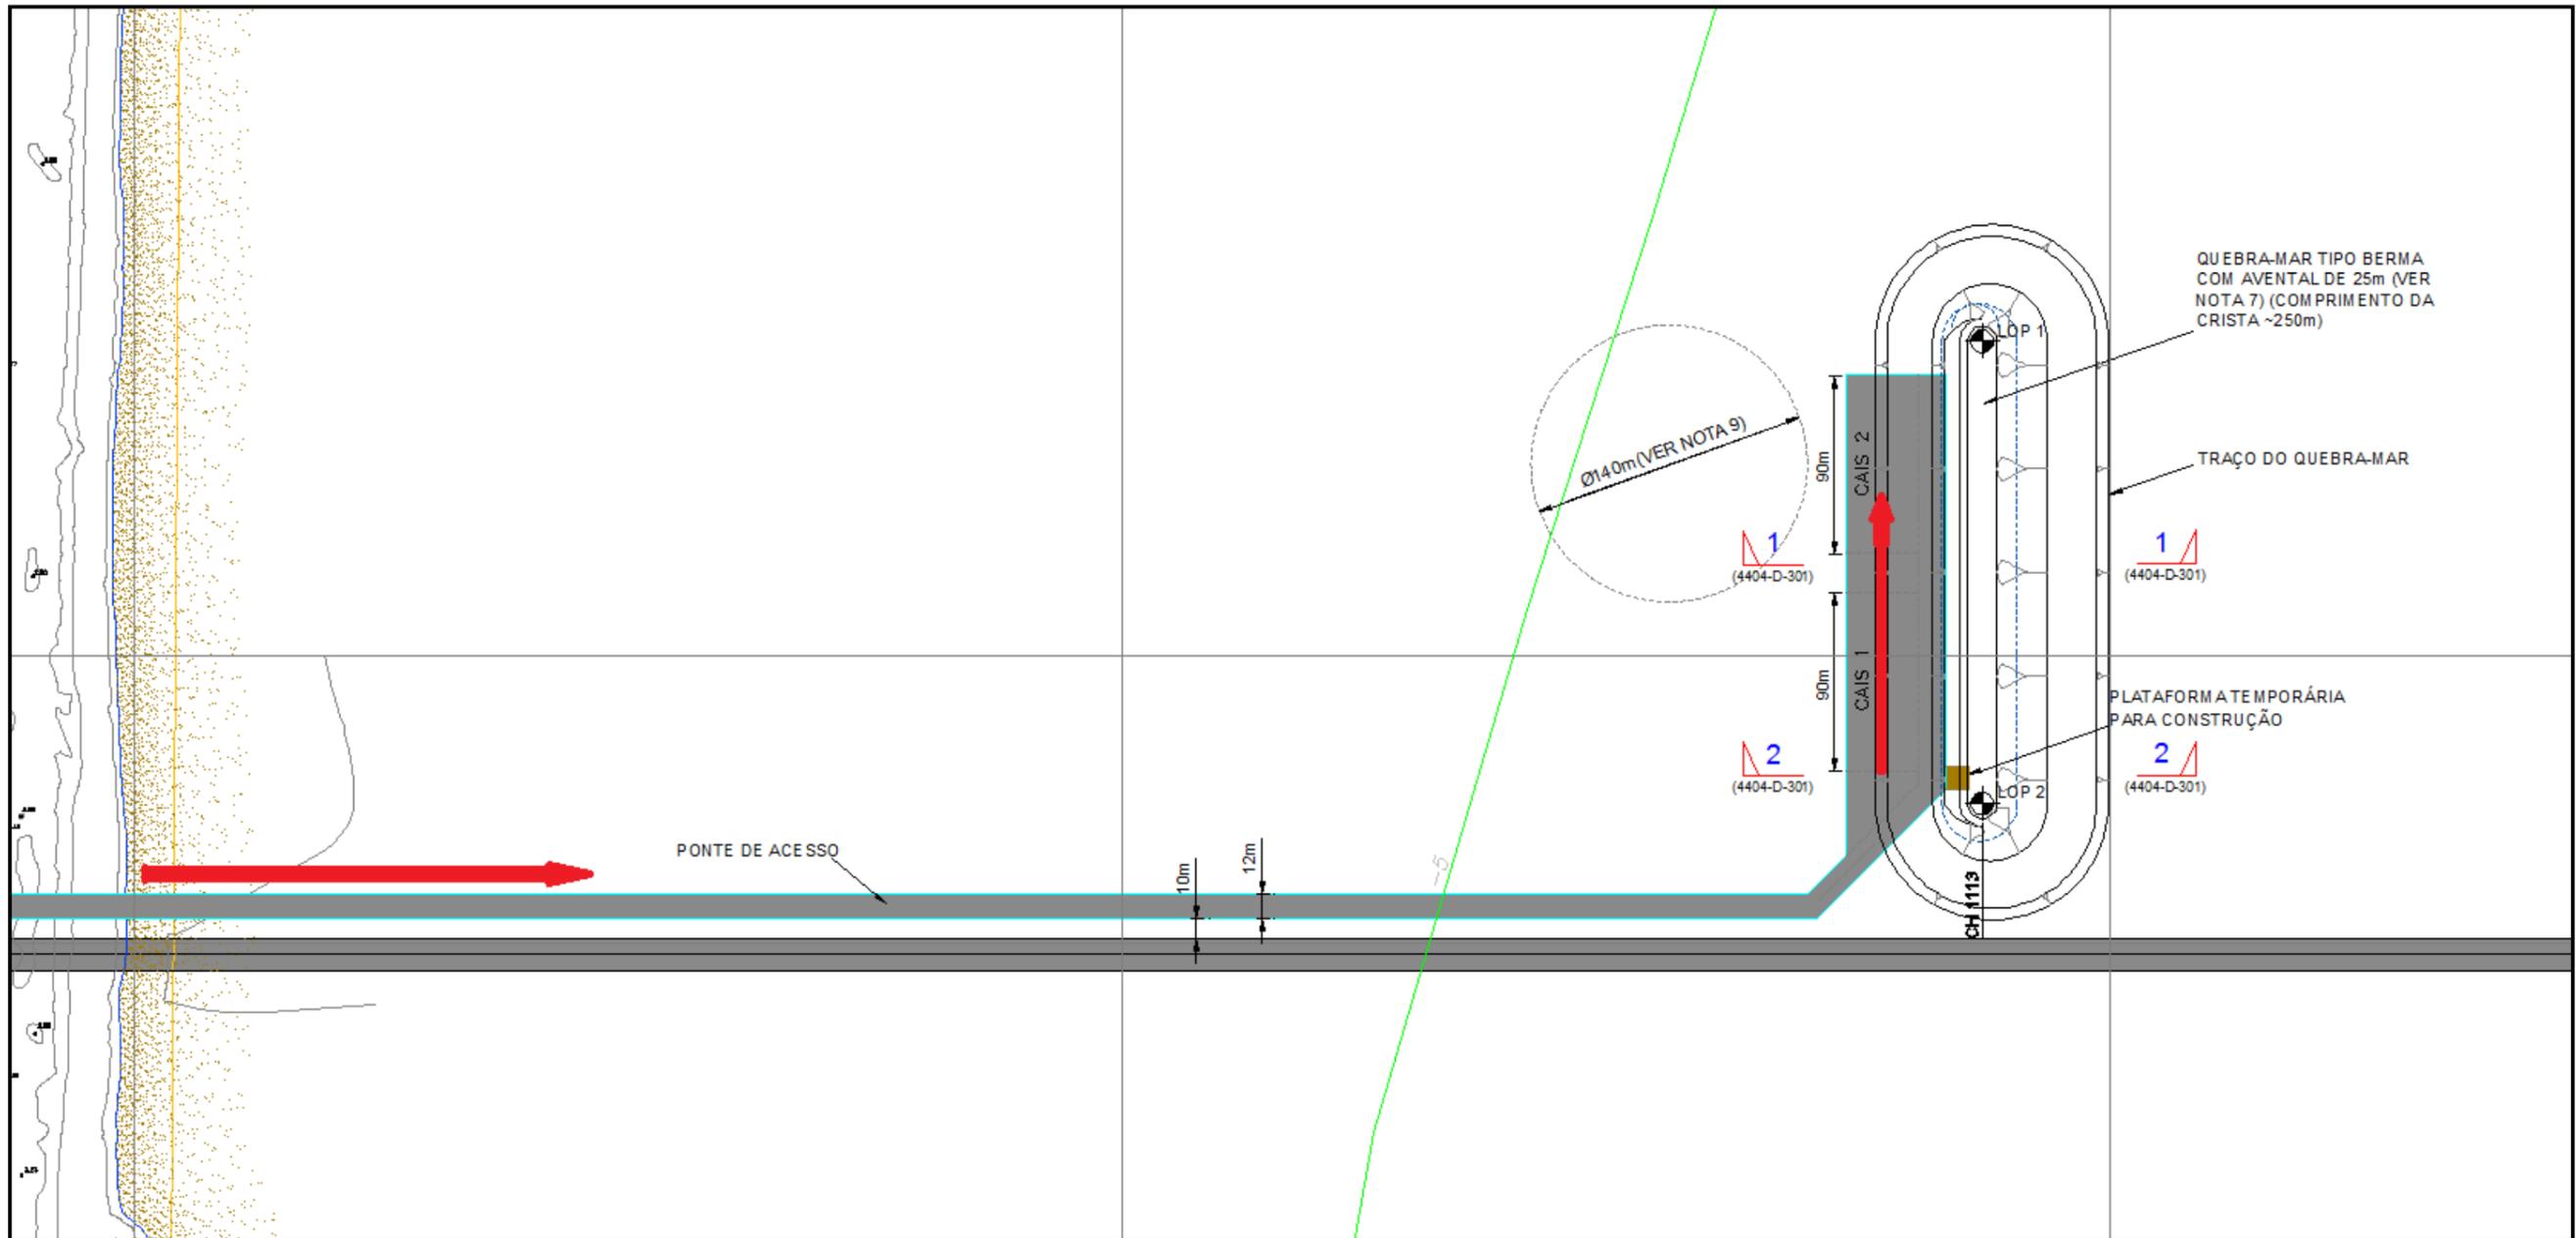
Figura 5.65 - Frentes de Trabalho para a Construção da Ponte de Acesso e Pier de Embarque Provisórios - Porto Sul
